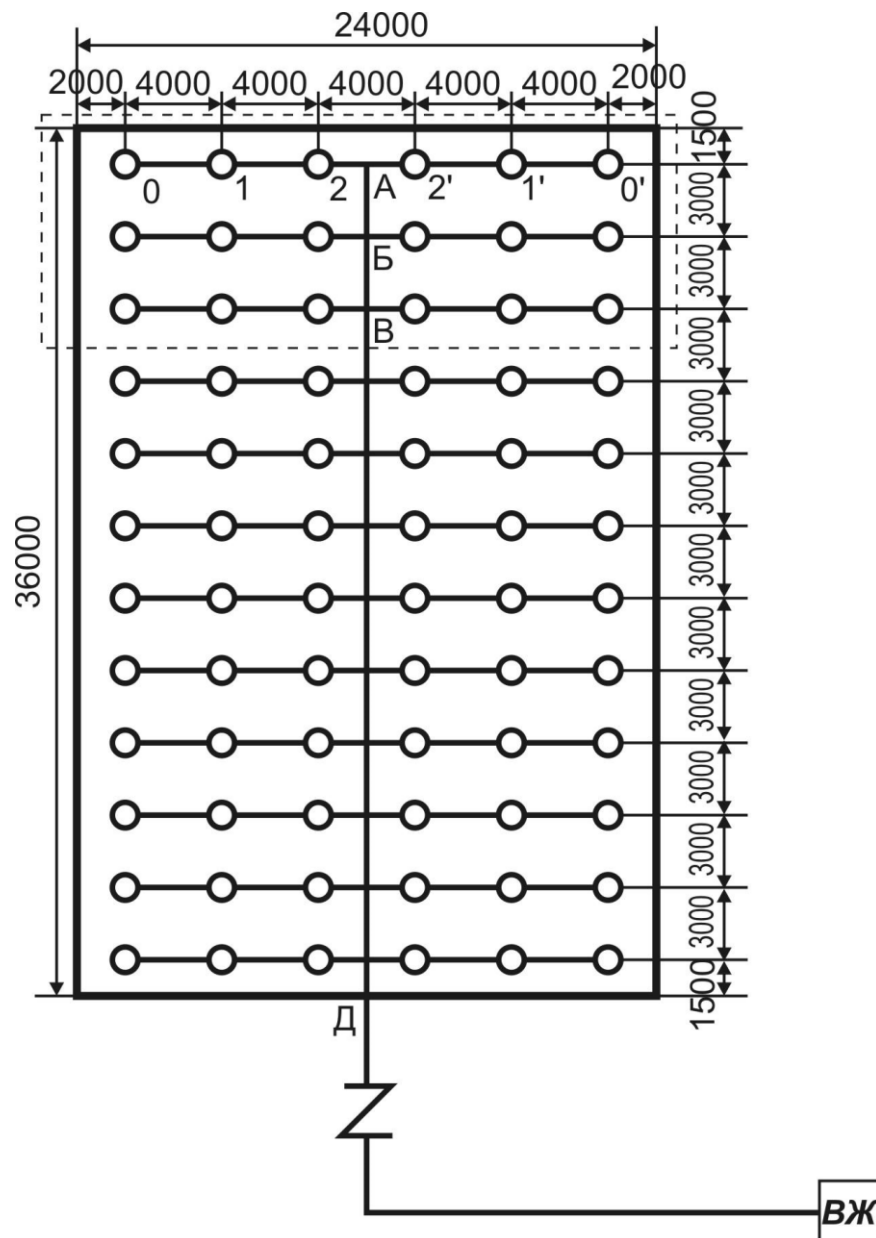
Розрахункова схема спринклерної установки пожежогасіння
